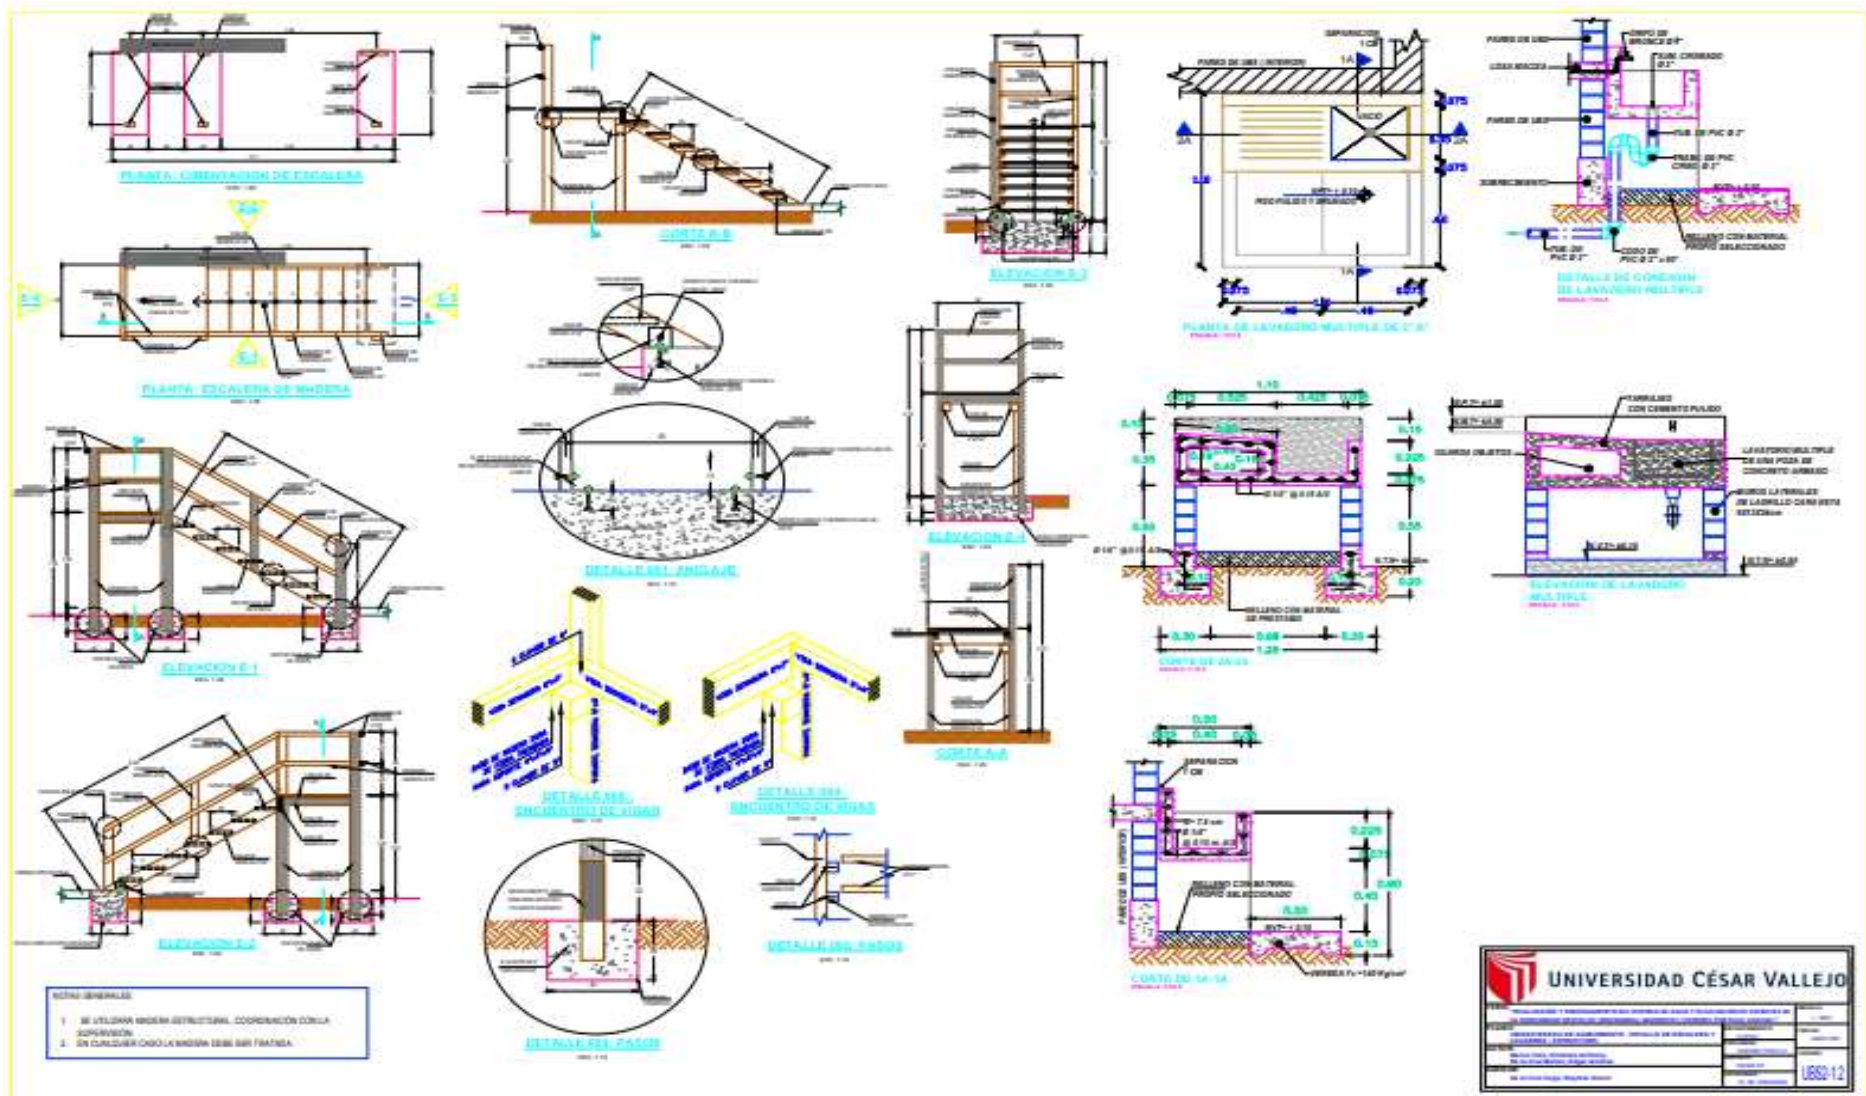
UBS 2-1.2 Caseta de UBS - Estructura
